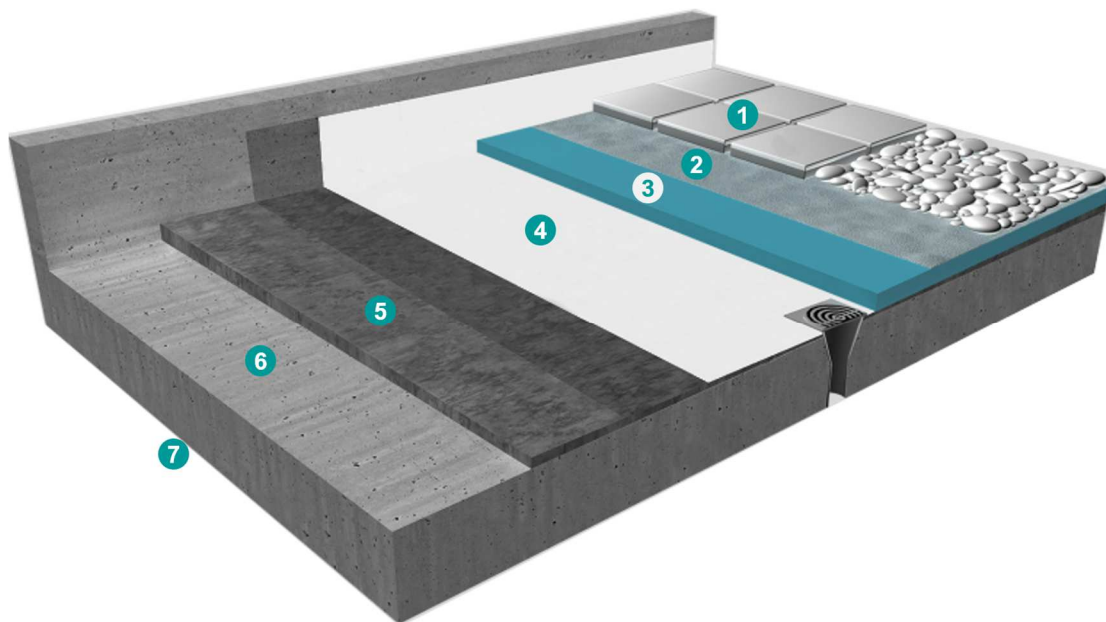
Detalle de cubierta invertida por capas. Elaboración propia
